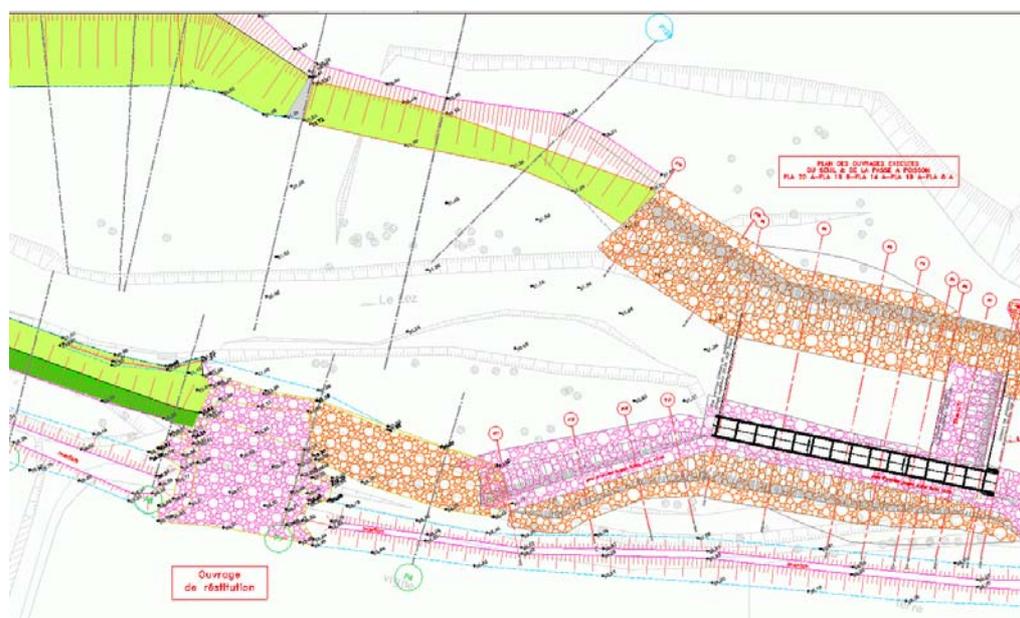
Extrait du plan de recollement au niveau du piège à graviers.
